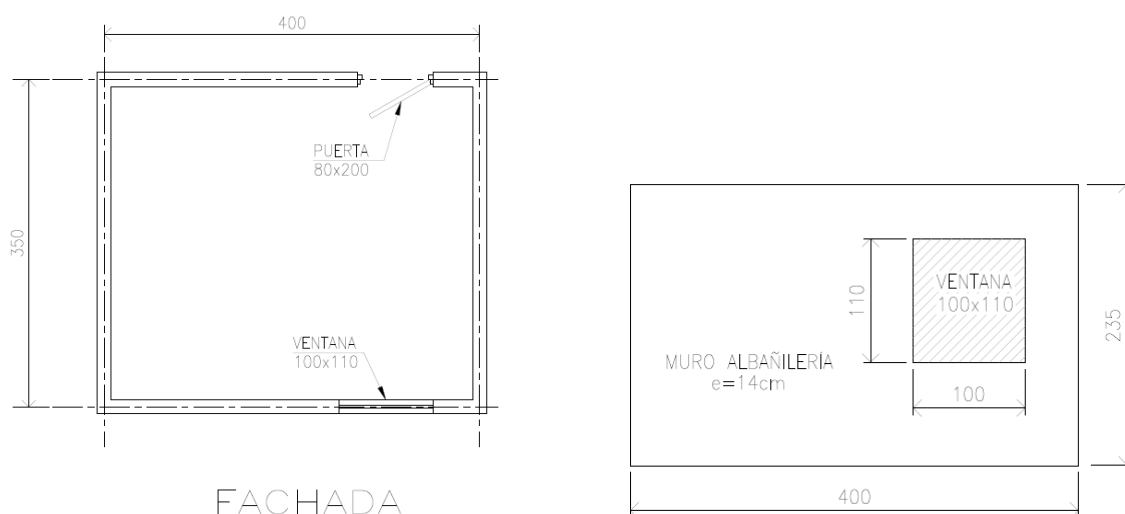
Vista en planta y elevación del recinto utilizado para el ensayo.
